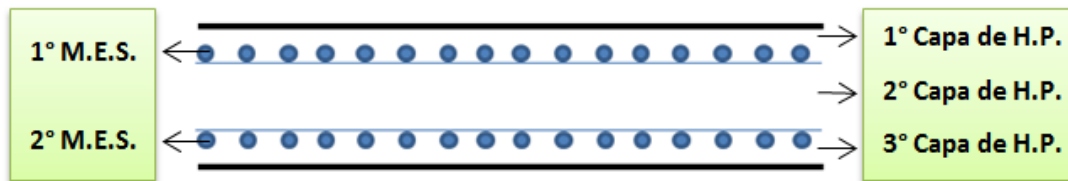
Esquema de estructura de muro de hormigón proyectado (vista en planta).
